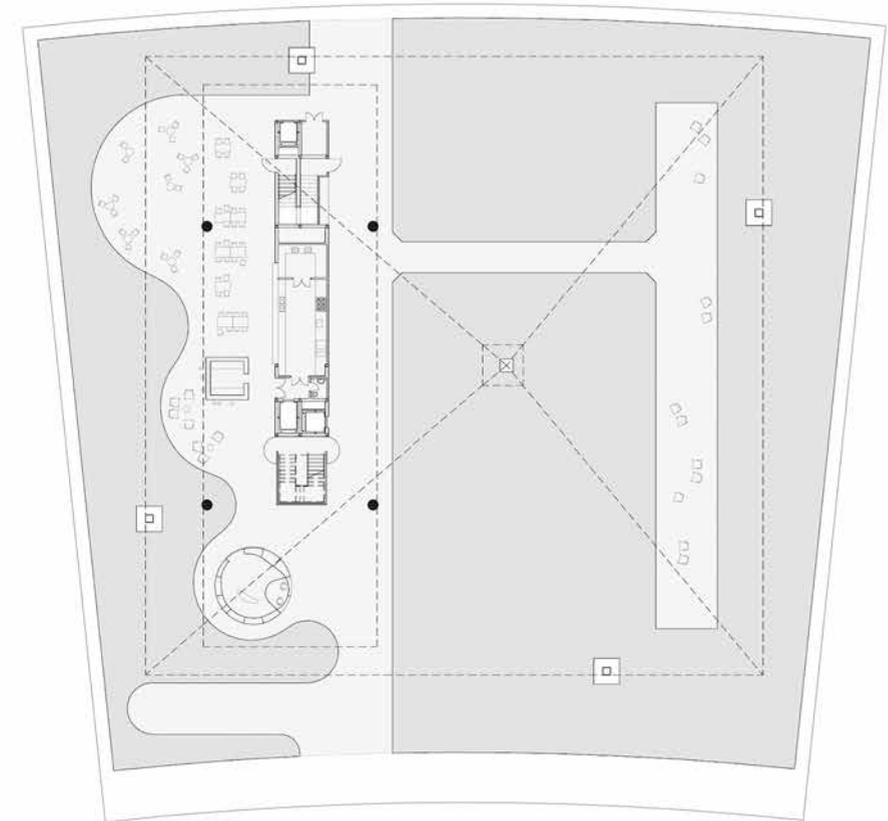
PLANTA BAJA. FUENTE: BEN-AVID
